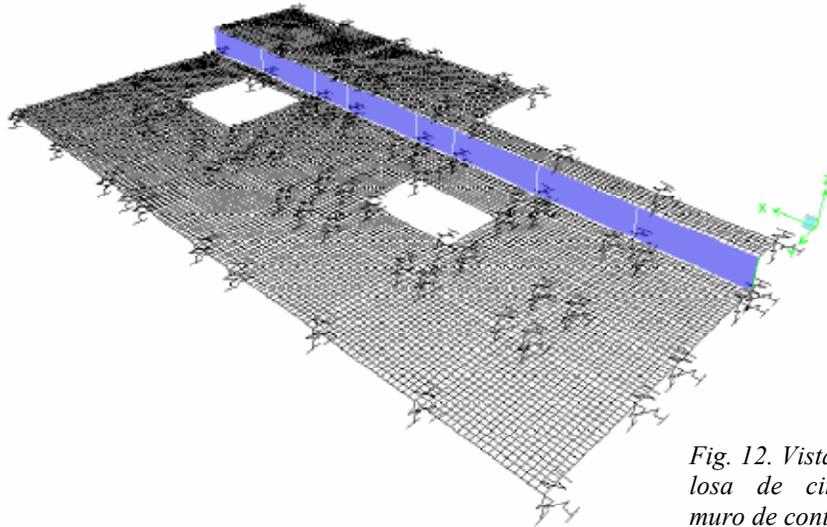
Vista global de la losa de cimentación y muro de contención.
